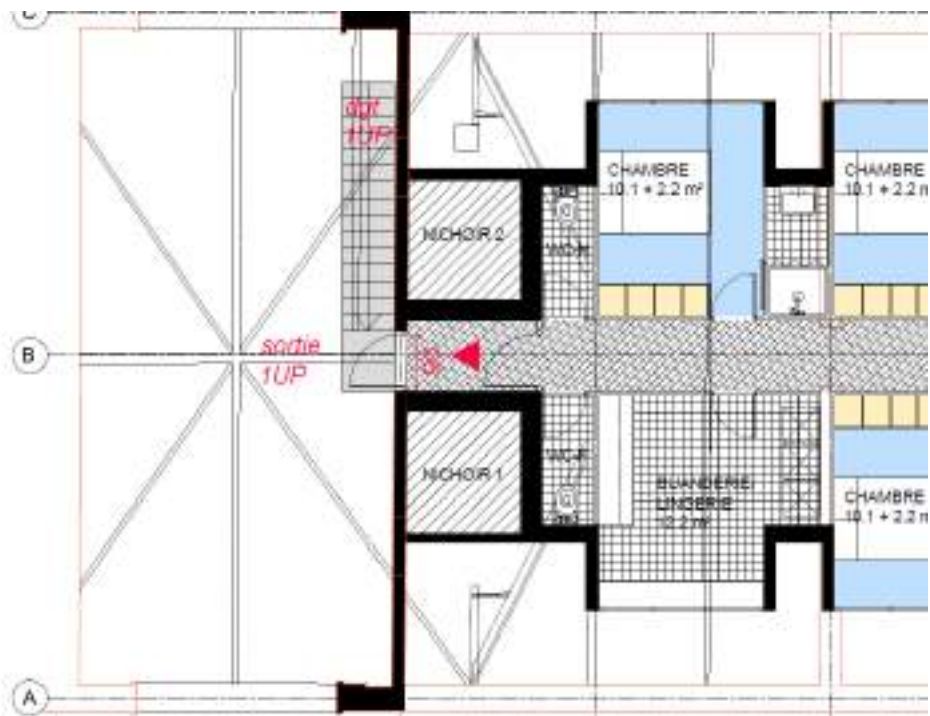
localisation des nichoirs sur le plan R+1, extrait du permis de construire
